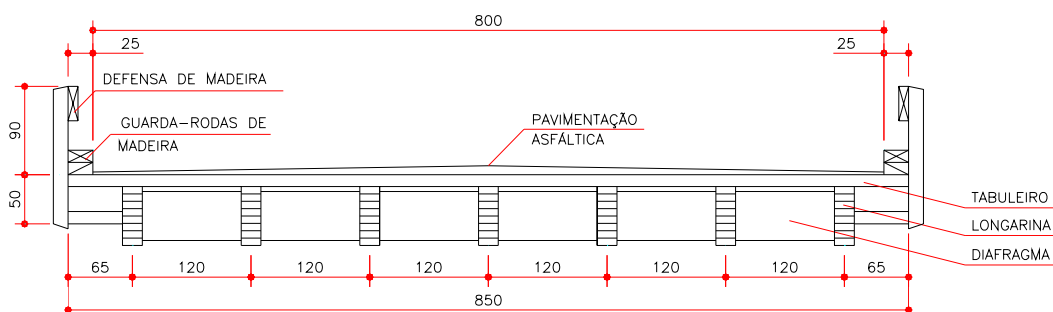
Seção transversal da ponte em vigas de MLC com duas faixas de tráfego
